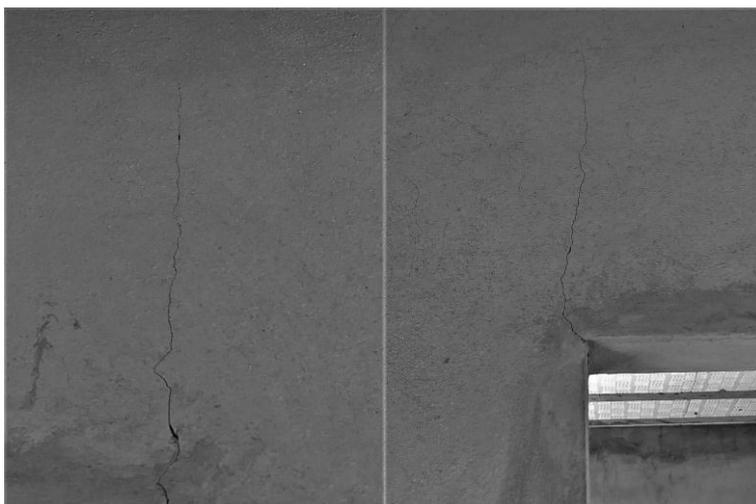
Fissuração Residência 1 – Porta de Entrada
